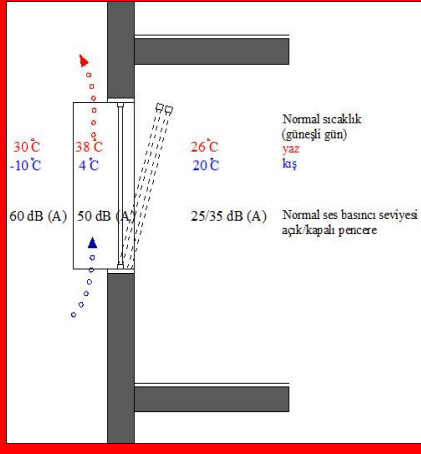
Alternatif cephe örnekleri (Hausladen ve diğ., 2006, s. 103)
